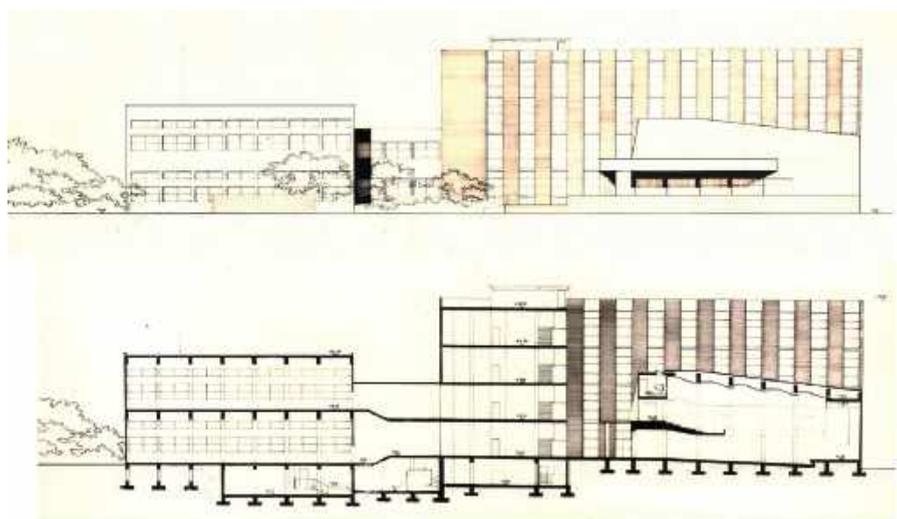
Prospetto nord-ovest (ingresso) e sezione nord-ovest
